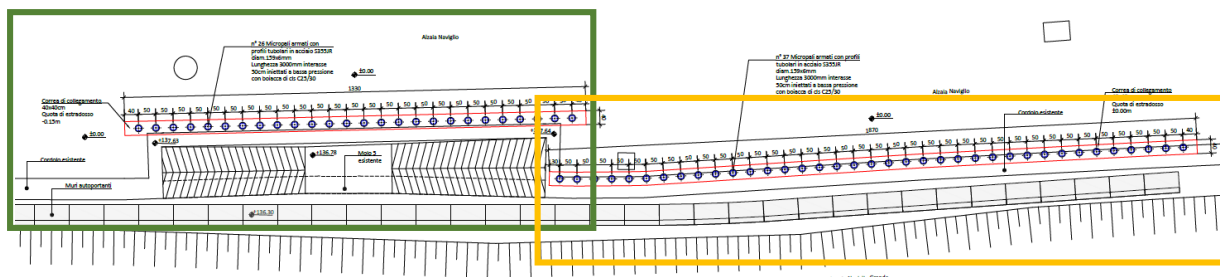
Estratto planimetrico di progetto (elab. 1183-D-G03-17-PLT) – verde manufatto di approdo – arancione tratto esterno al manufatto.
